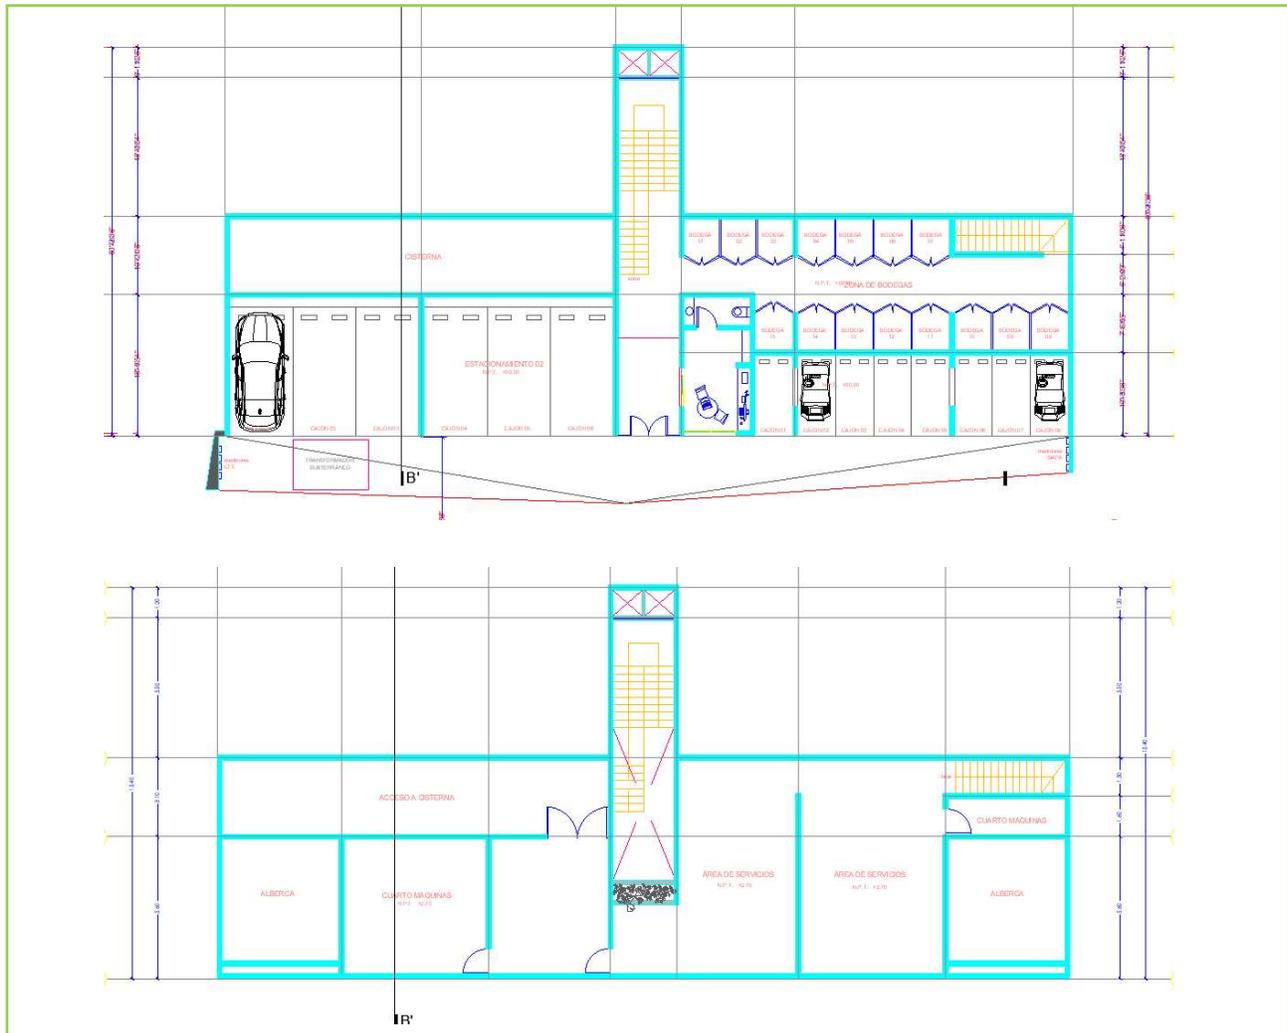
Detalle del diagrama de la planta baja del Edificio A
